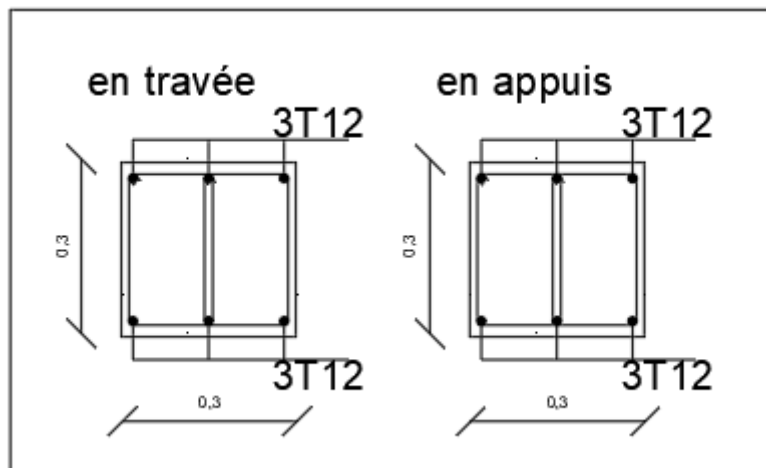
Dessin de ferrailage de la poutre palier.
